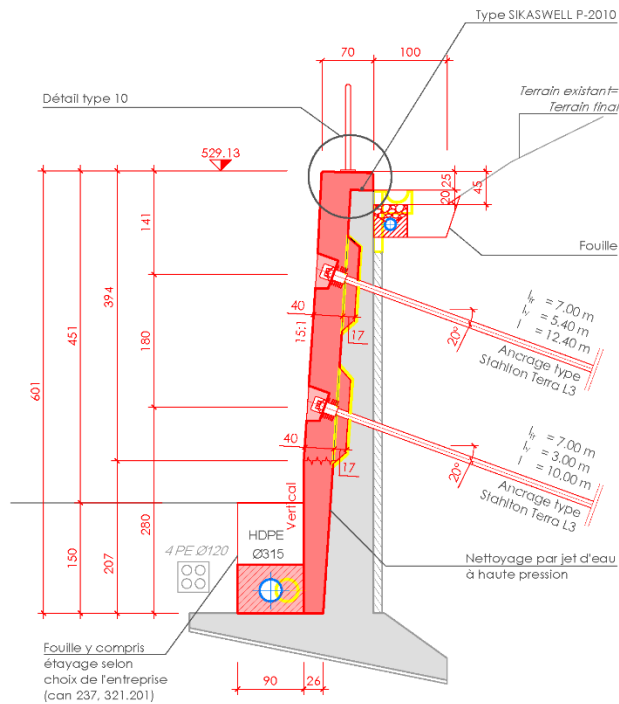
Coupe type renforcement par la mise en place d'ancrages actifs
